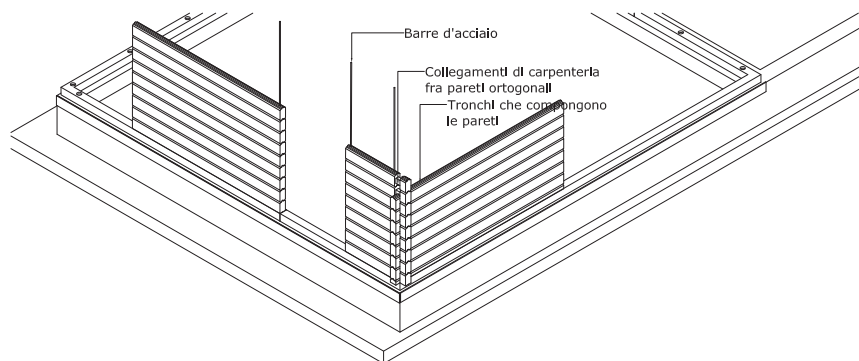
Collegamento fra pareti d'angolo e collegamento alle fondazioni in un edificio Log House.
